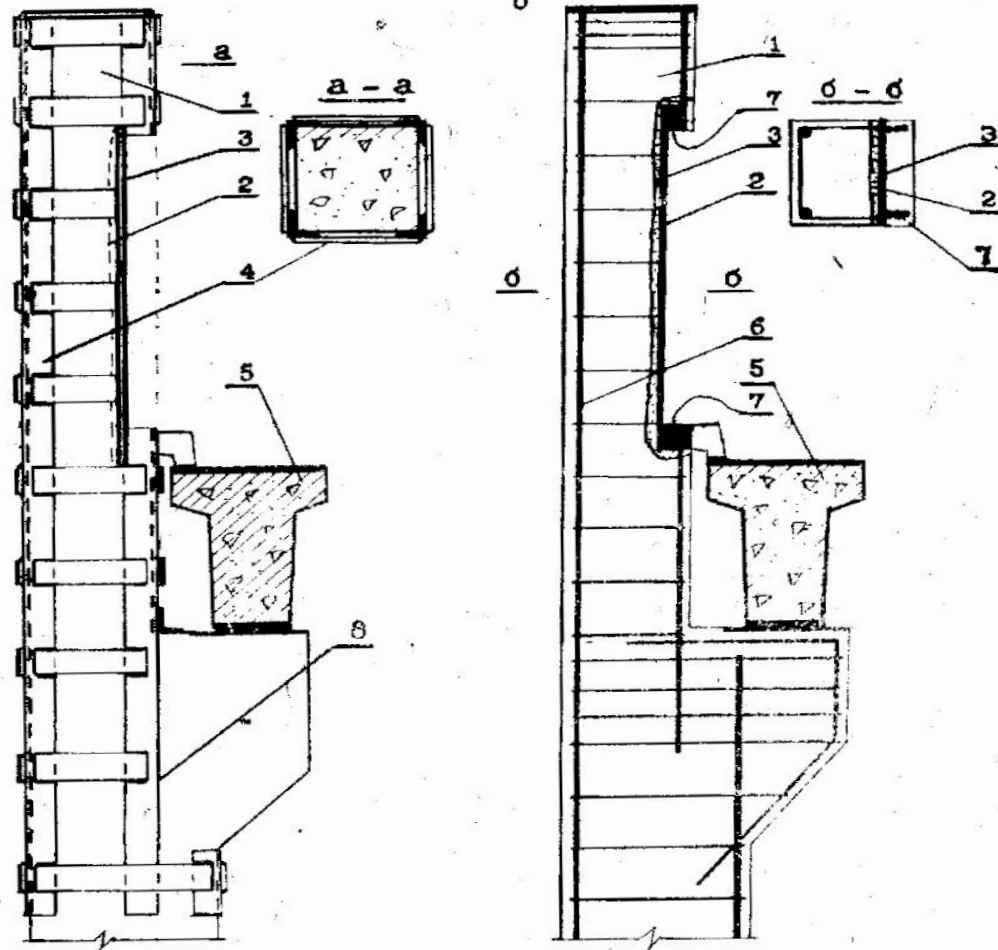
Устройство выреза в железобетонной колонне при увеличении габаритов мостовых кранов:
